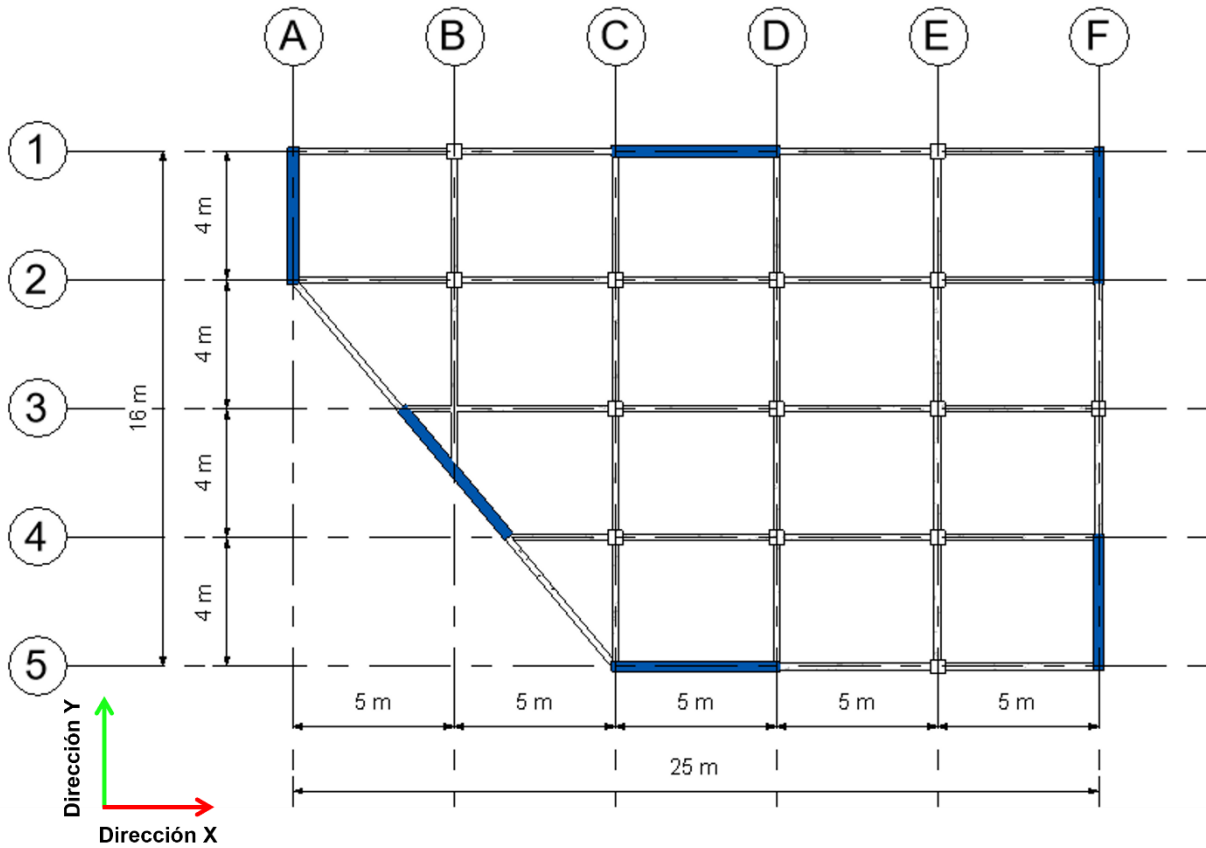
Planta tipo para el edificio estructurado con marcos y muros. Fuente: elaboración propia.
